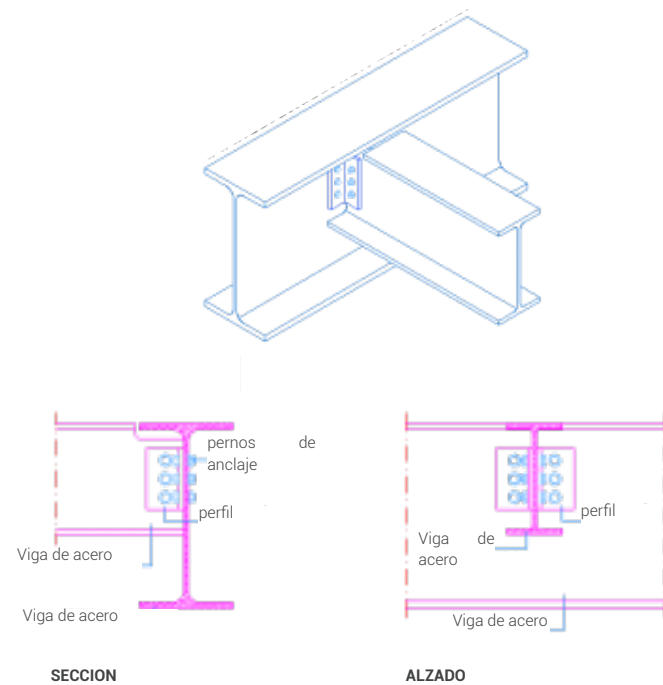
Detalle de anclaje de una columna y una viga Fuente: Elaboración propia.
